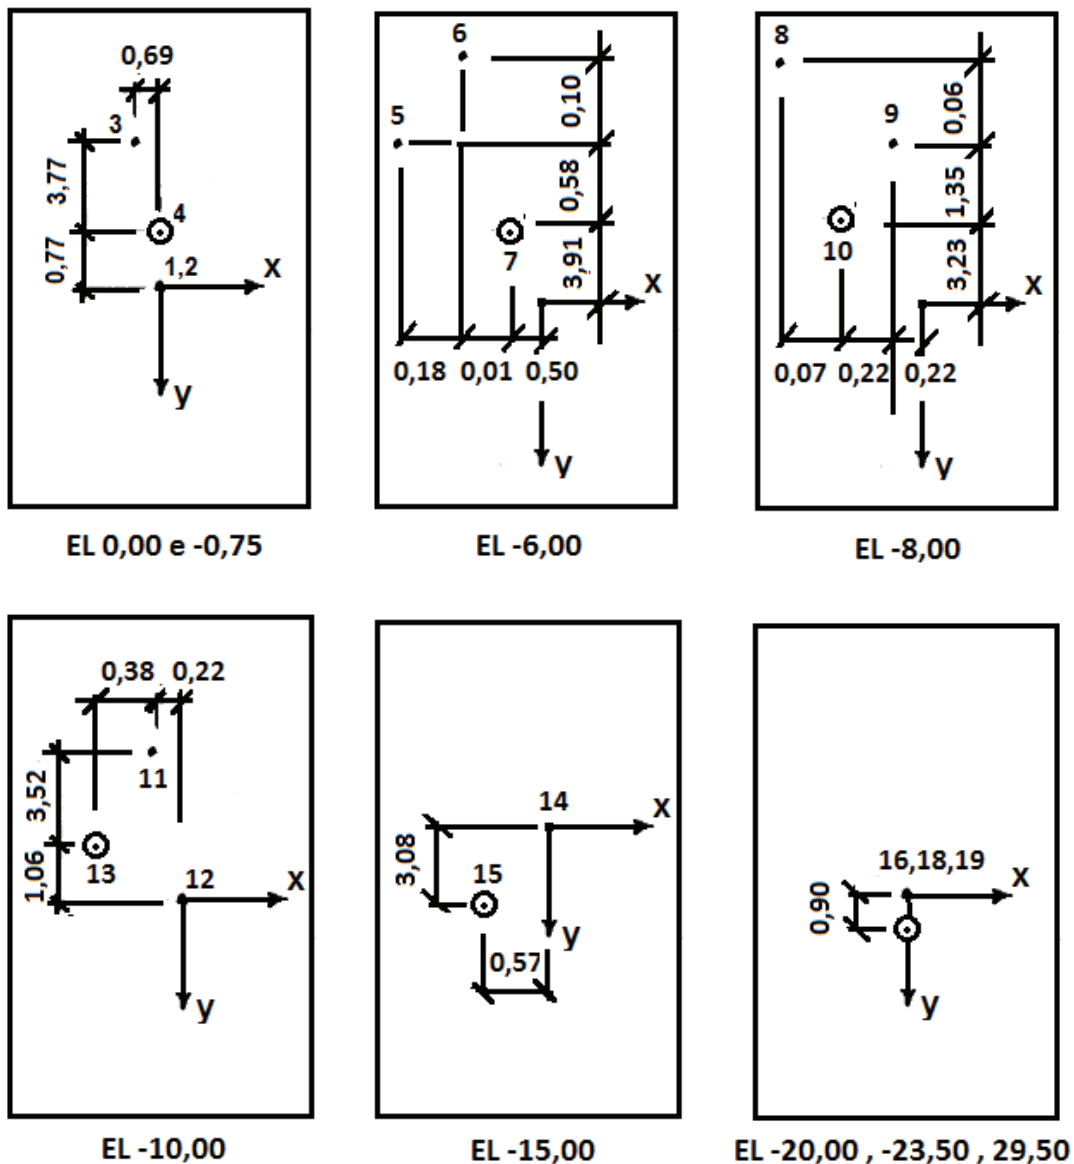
Locação em planta dos nós do modelo – (Unidade: m).
